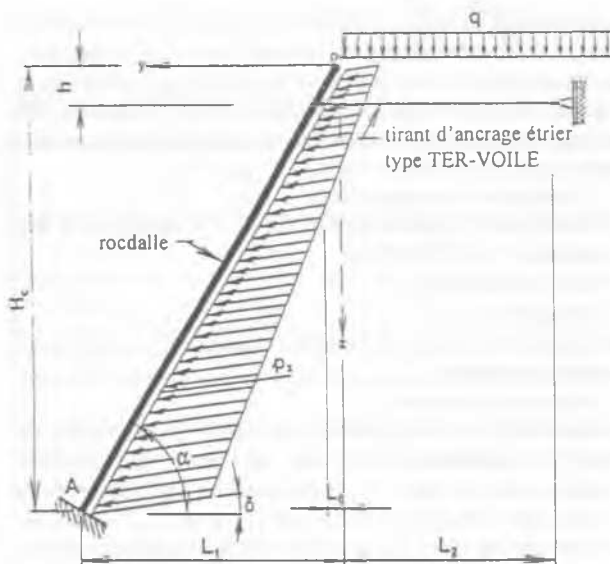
Sollicitations sur l'élément structural rocdalle
